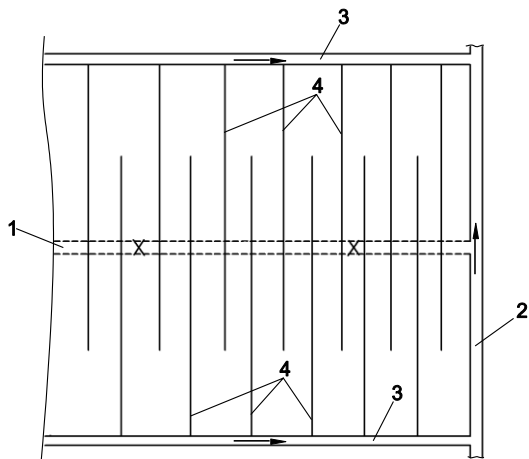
Схема реконструкции открытой осушительной сети на разреженную систему одиночных дрен:
